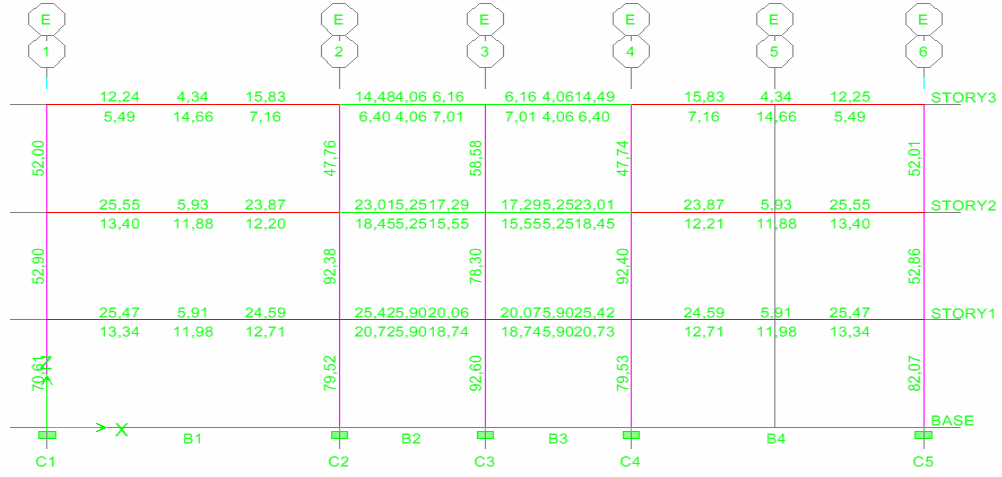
K2 kirişi betonarme analiz bilgileri
